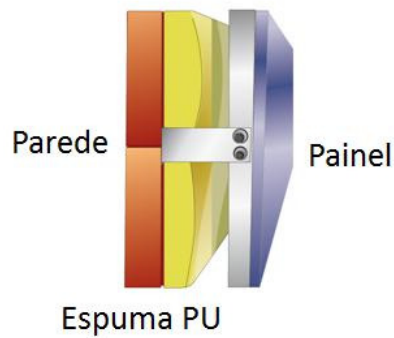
Esquema de fachada ventilada ⁽²⁷⁾
